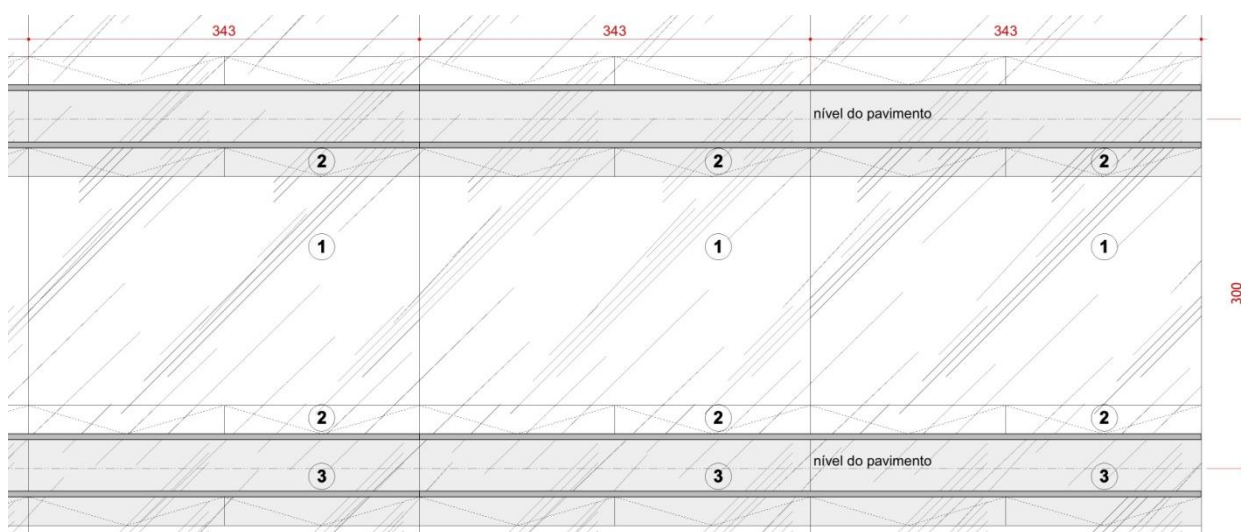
Módulo da fachada dupla ventilada proposta – elevação parcial.
